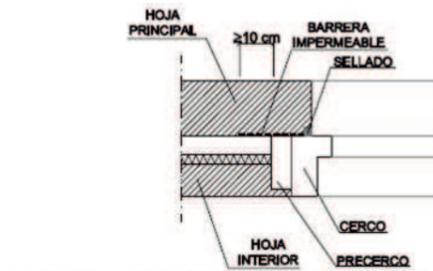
Ejemplo de encuentro de la fachada con la carpintería
